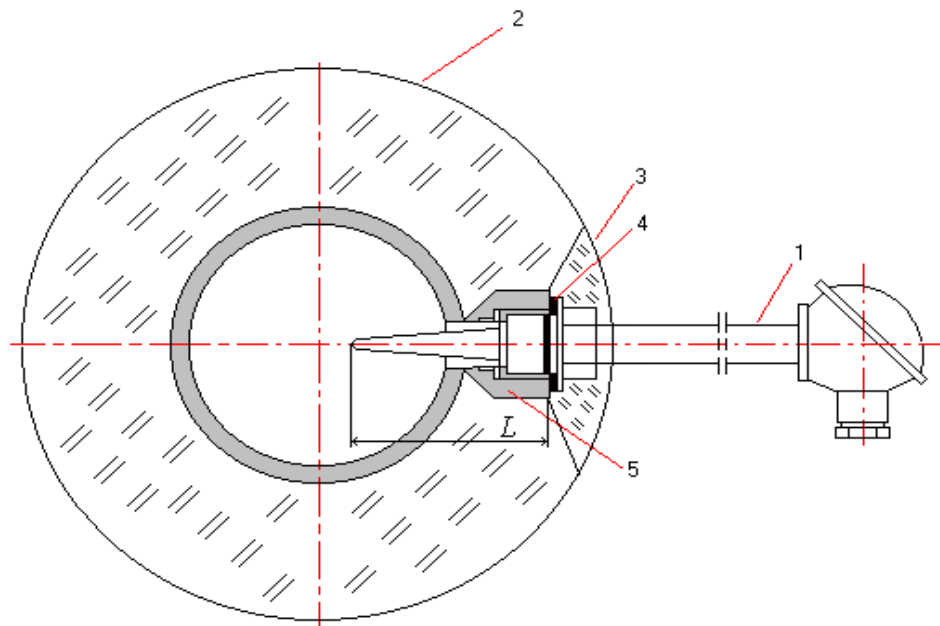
Схема встановлення термоперетворювача на трубопроводі для вимірювання температури перегрітої водяної пари: 1 – ТП; 2 – ізоляція; 3 – шар ізоляції, що легко знімається; 4 – прокладка; 5 – бобишка; L – монтажна довжина.
